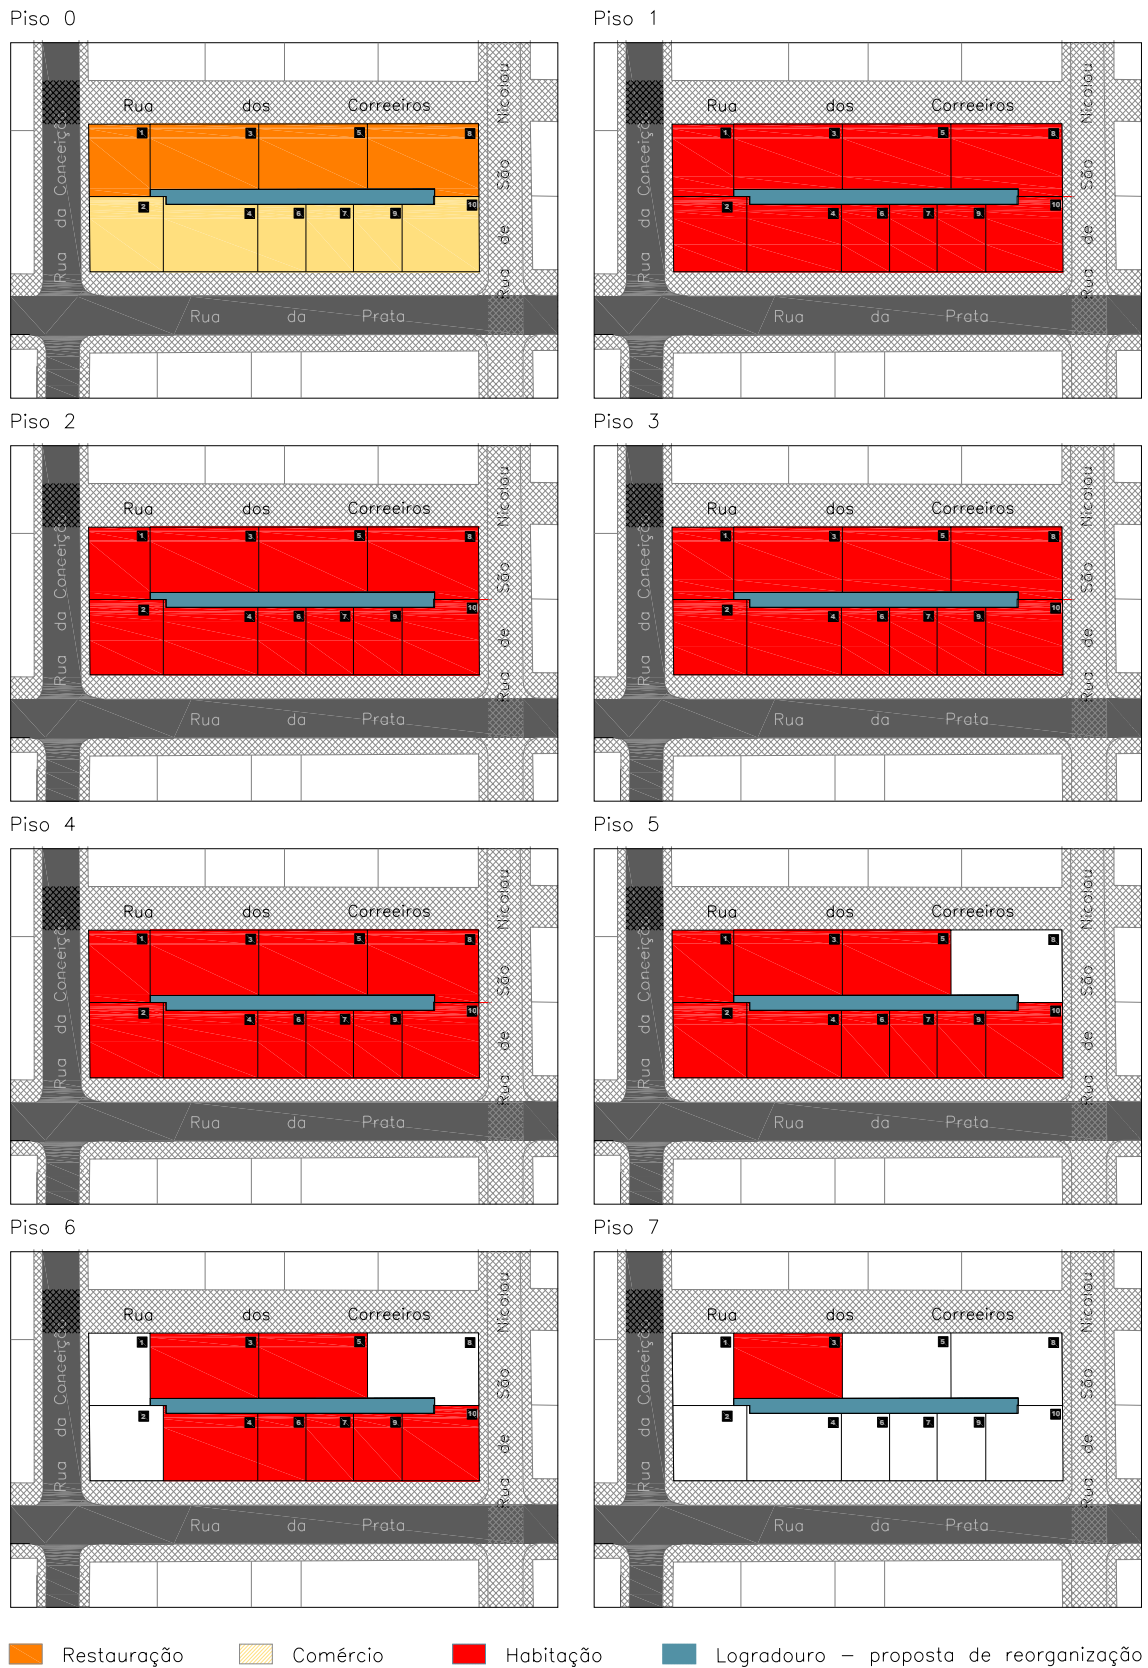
Plantas de Zonamento e Organização Espacial por piso
